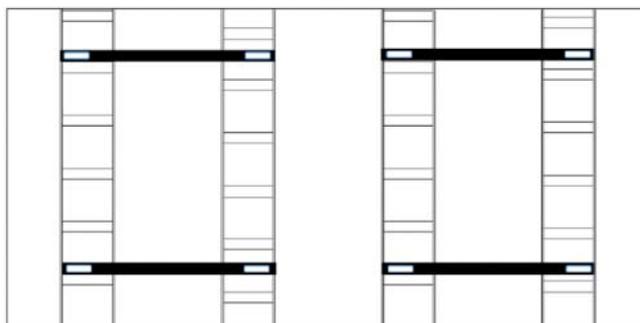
Vista in pianta dell'implementazione della soluzione in uno scalo.
